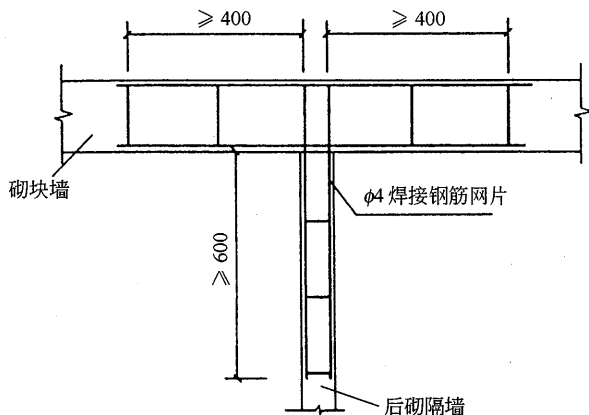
砌块墙与后砌隔墙交接处钢筋网片
